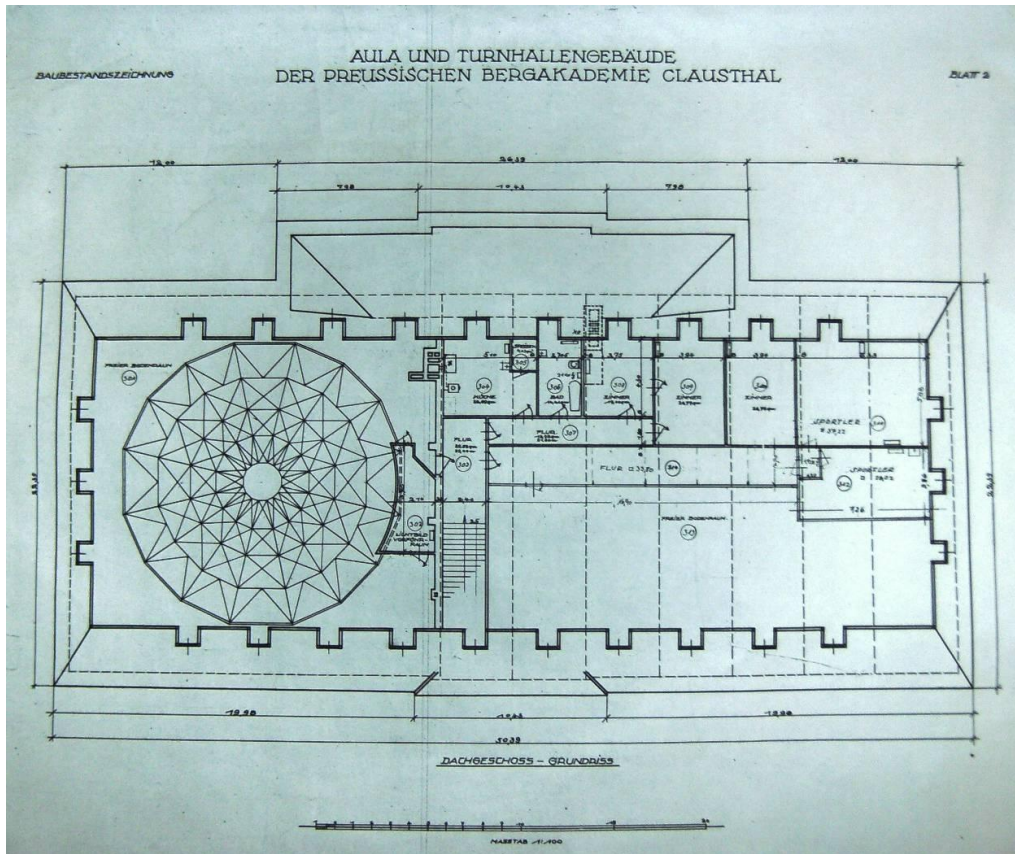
Aula und Turnhalle. Grundriss des Dachgeschosses.
